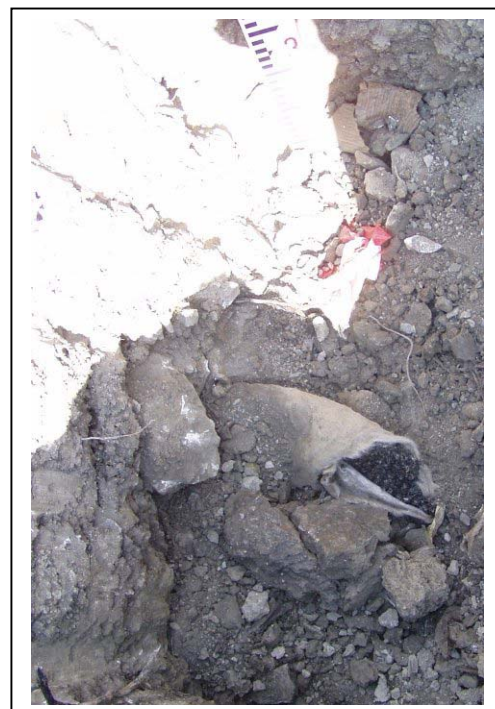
er – particolare del materassino drenante, rinvenuto a fondo scavo, sui rifiuti
